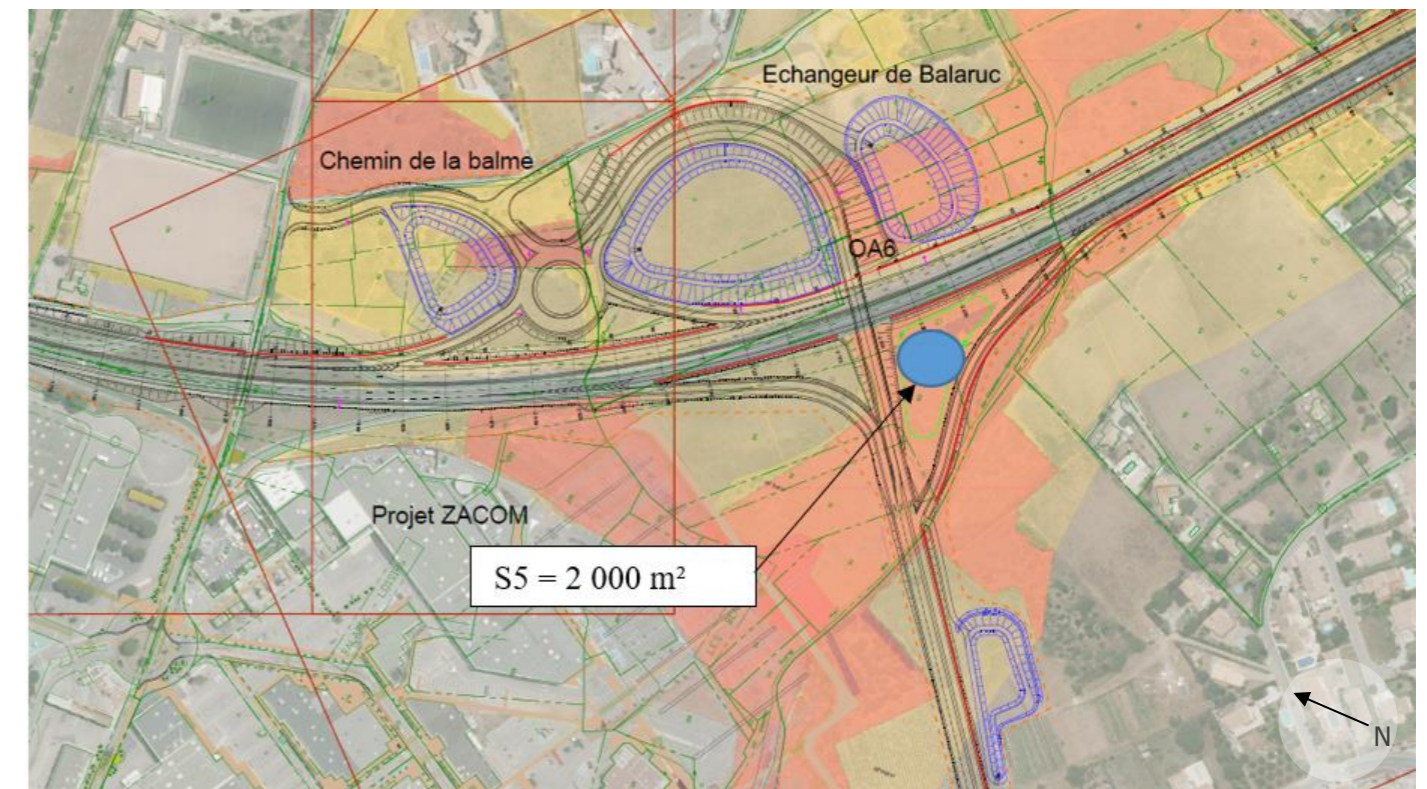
Zone pouvant accueillir les installations de chantier de la phase 3 - échangeurs Balaruc et RD2
